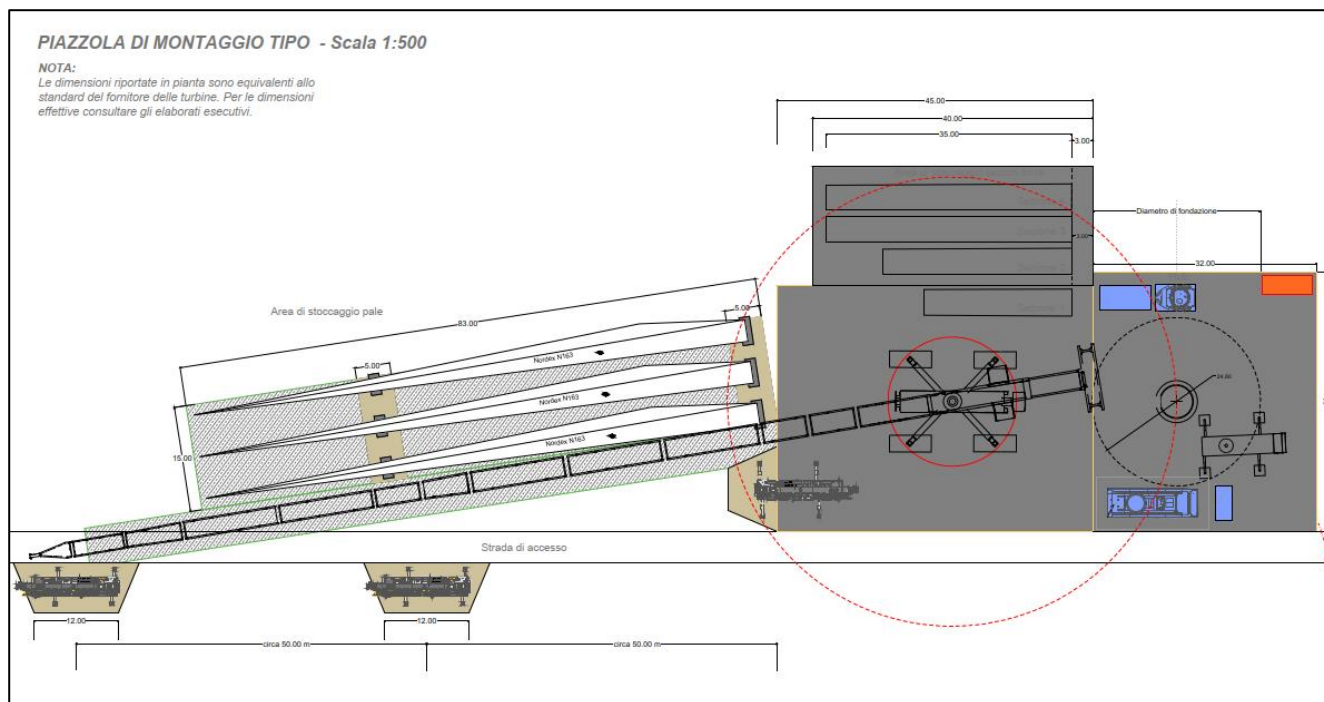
Posizione Cabina di raccolta (arancione) e vista in pianta con gru da 200t
